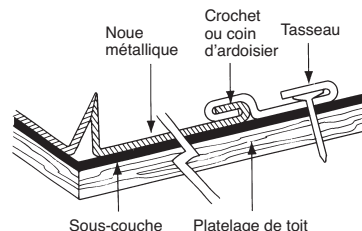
Noue ouverte typique fixée par des taquets.
